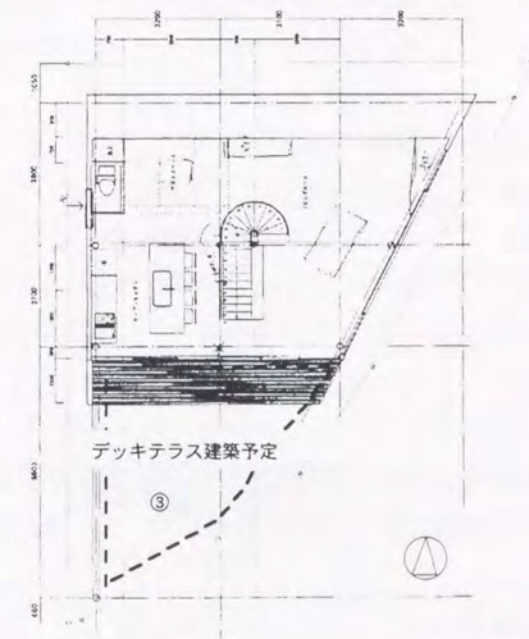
NI邸 2階平面図(1999.11.26) 1/200
